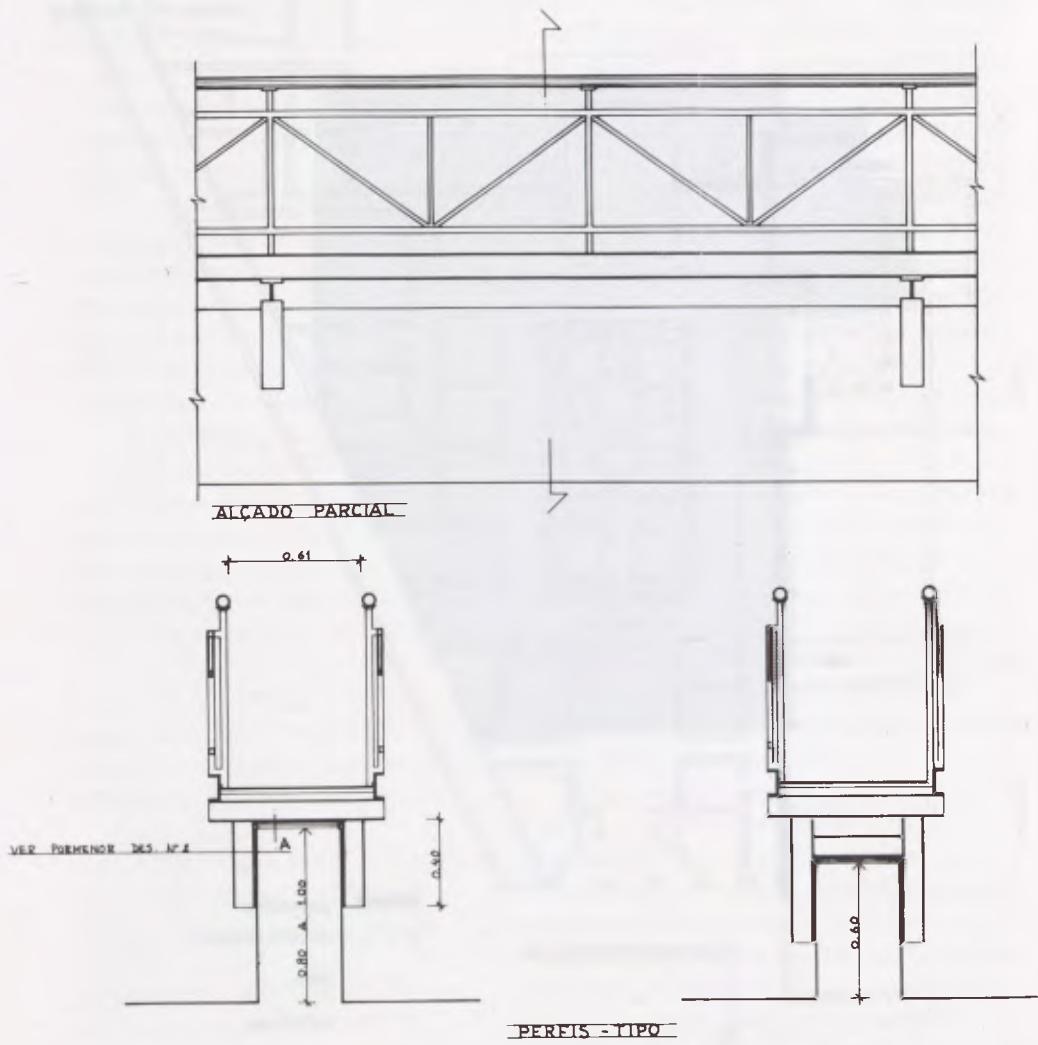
Alçado parcial e perfis-tipo do passadiço metálico.
